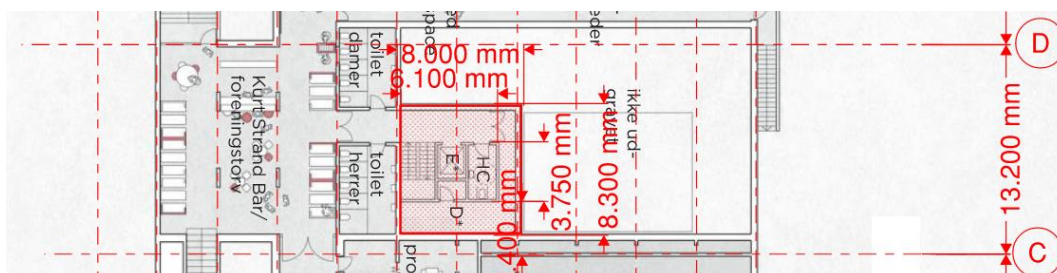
Plantegning af opbygning af armeret betondæk DÆK 300 ved fladt tag samt tag over skrå pulstag, modullinie B og C.
